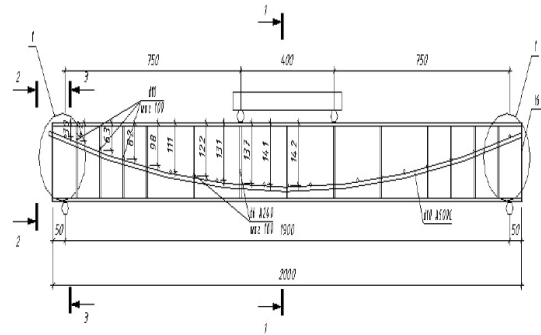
Сталежелезобетонная балка с арматурой по огибающей эпюры моментов
